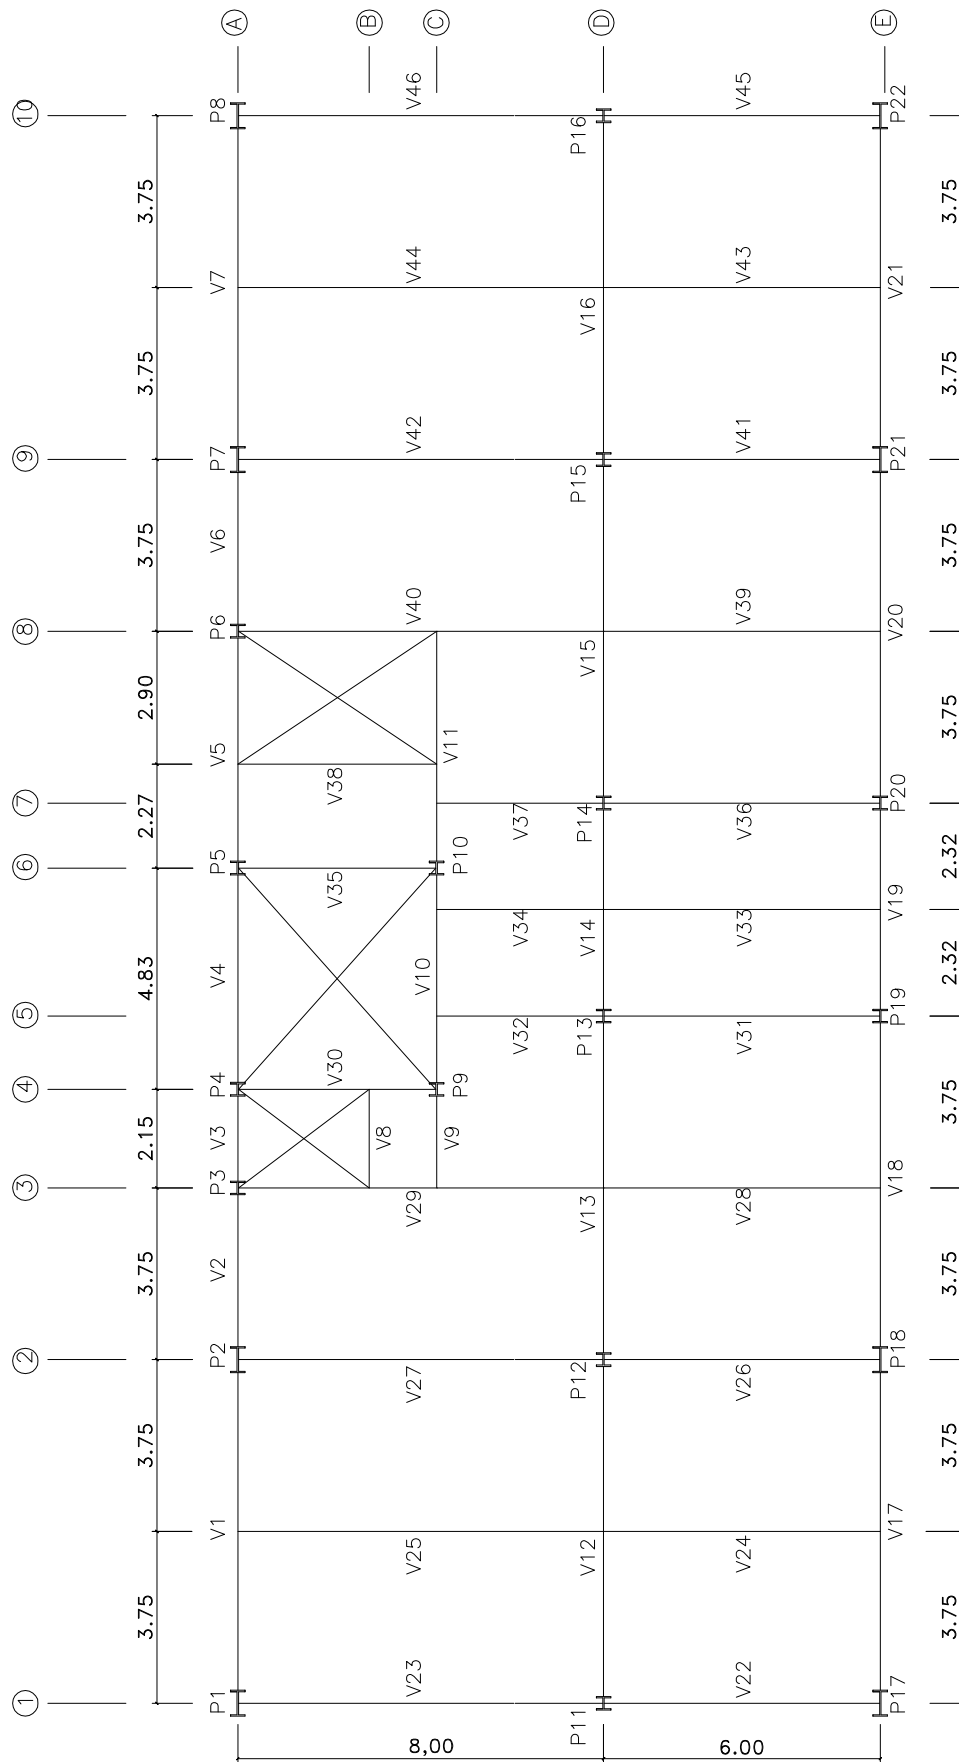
Disposição de vigas e pilares para o projeto utilizado por Pires Filho (2011) – dimensões em metros.
